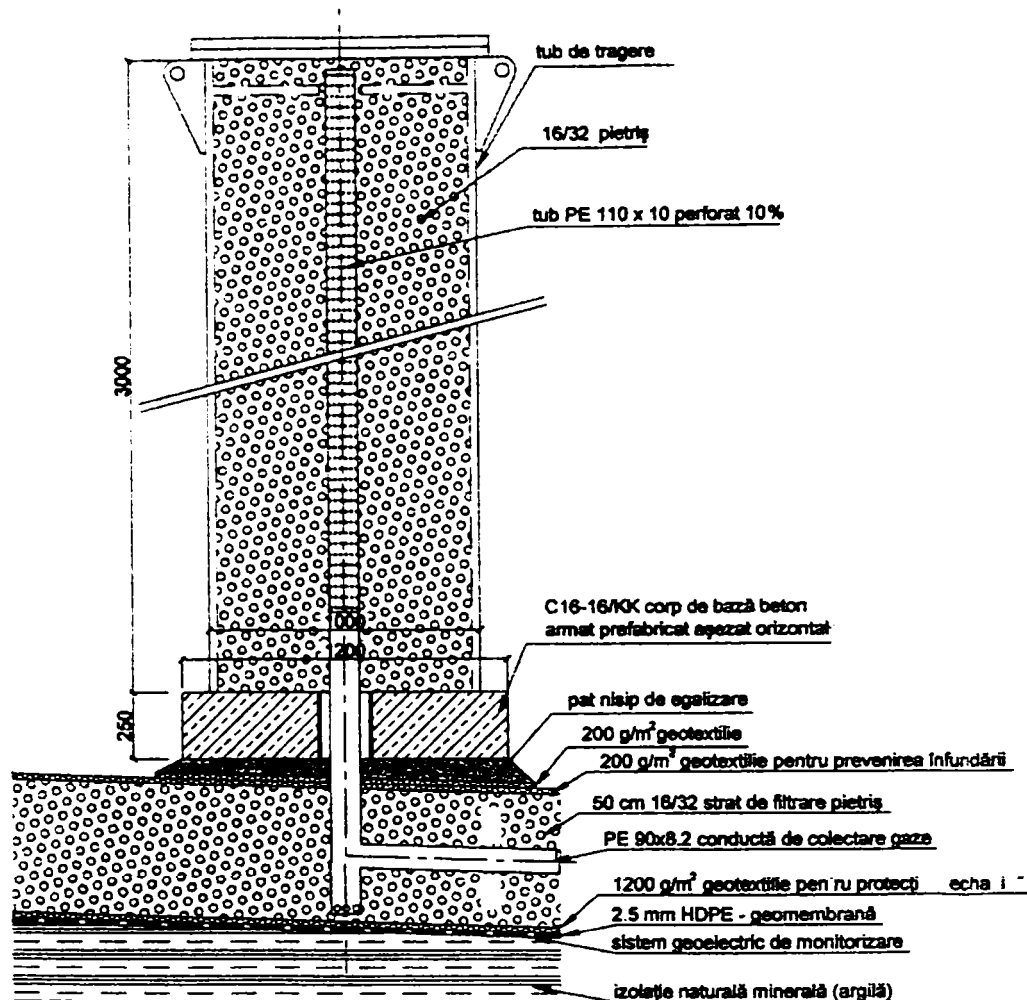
secțiune transversală – plan punct control al gazelor din depozit
